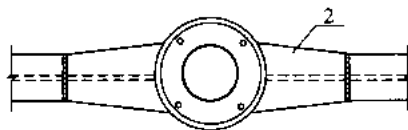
等截面悬臂钢梁与钢管混凝土柱
